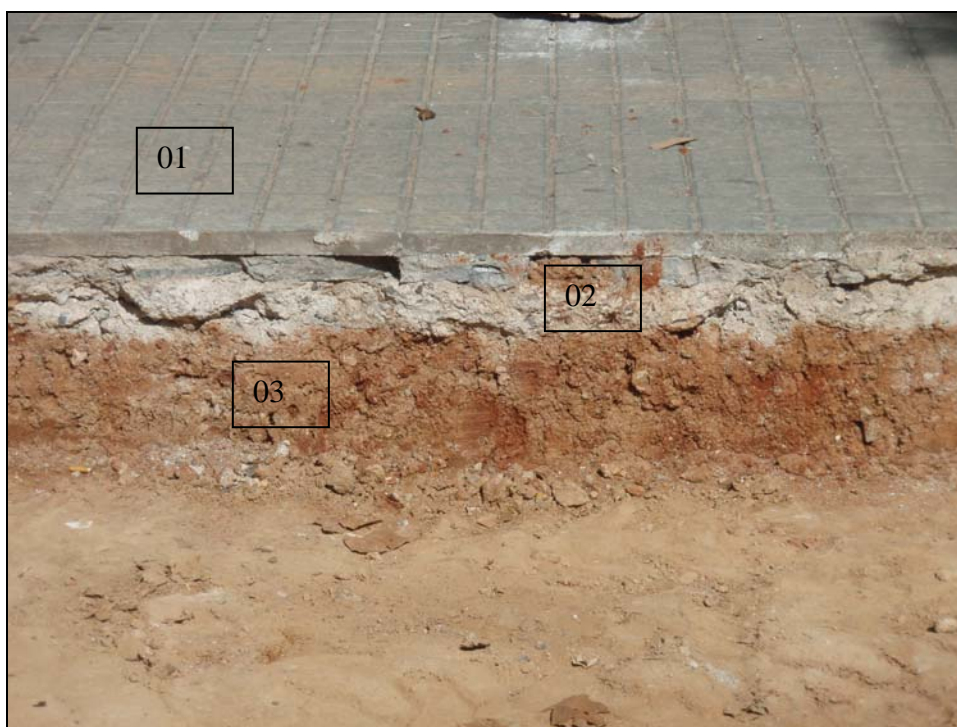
Foto en detall del final de les tasques de rebaix, sector nord
